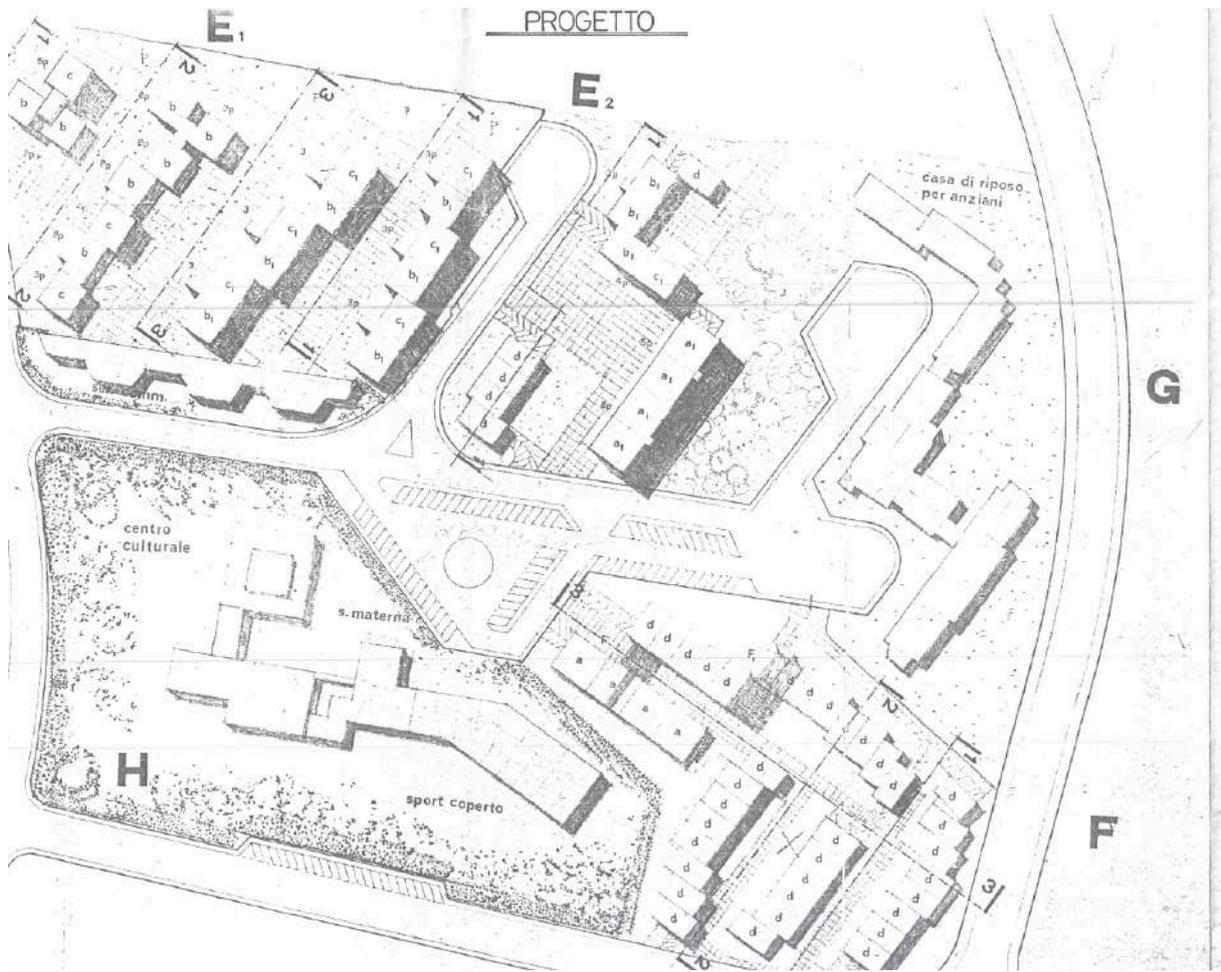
Stralcio planivolumetrico di progetto – Comparti E1, E2, F, G e H
